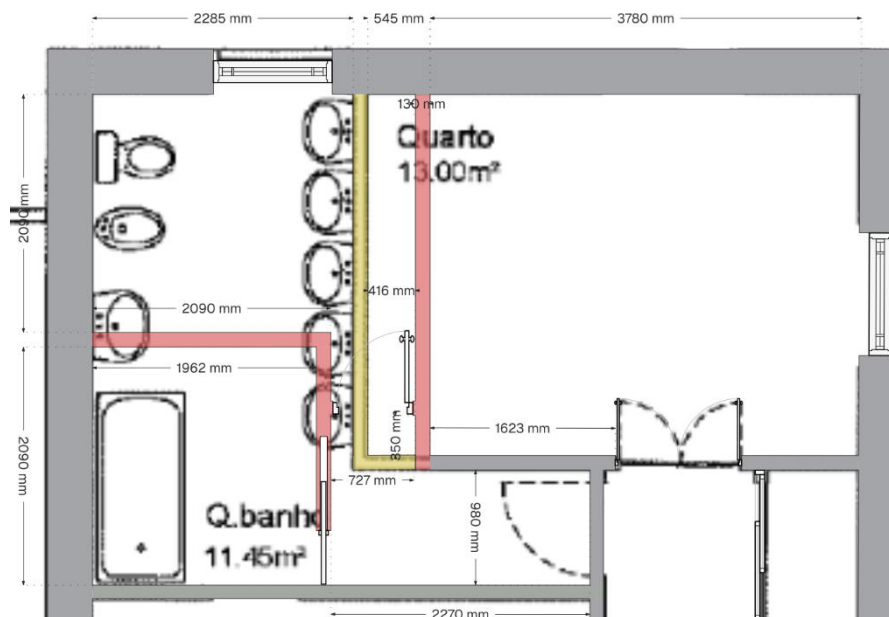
Representação técnica das paredes a demolir/construir nas casas de banho *Fonte: Autora.
